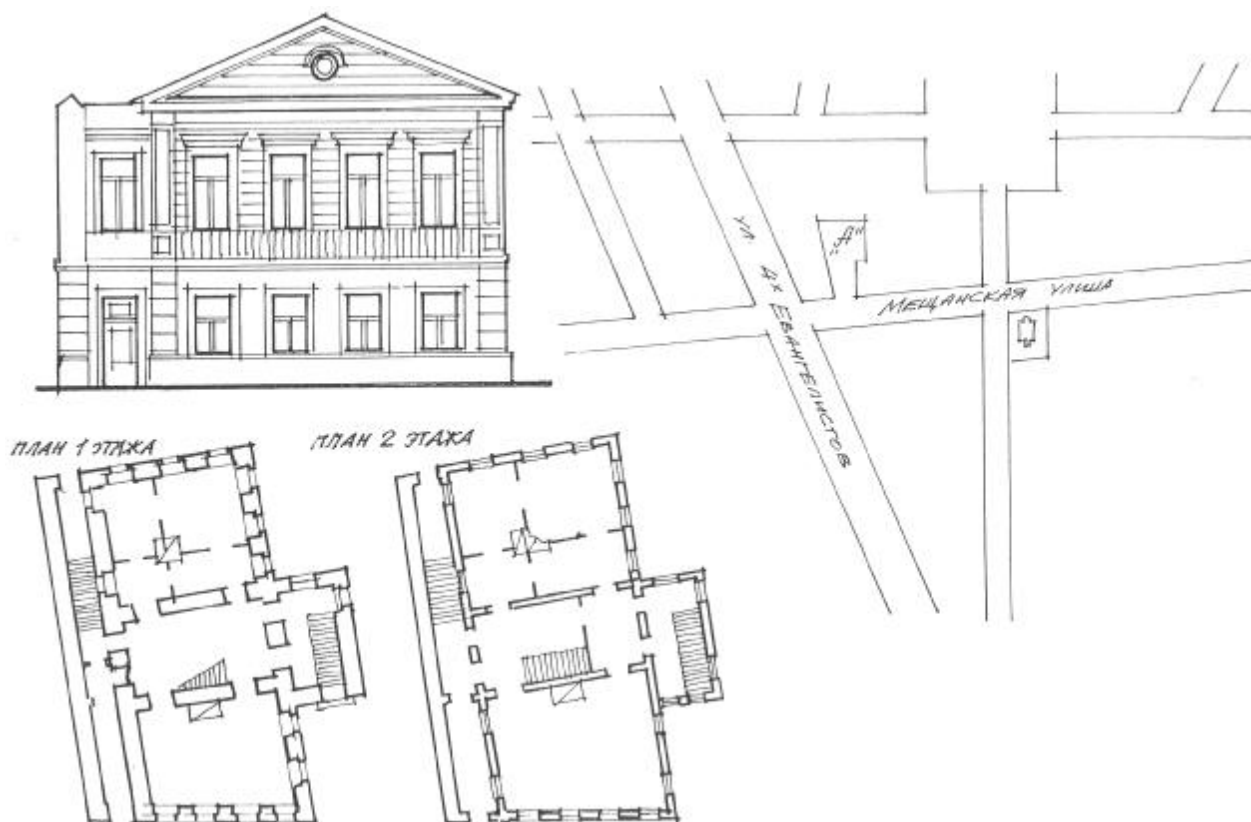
Генплан, фасад и планы дома Шаги Забитова. Проект 1868 года
